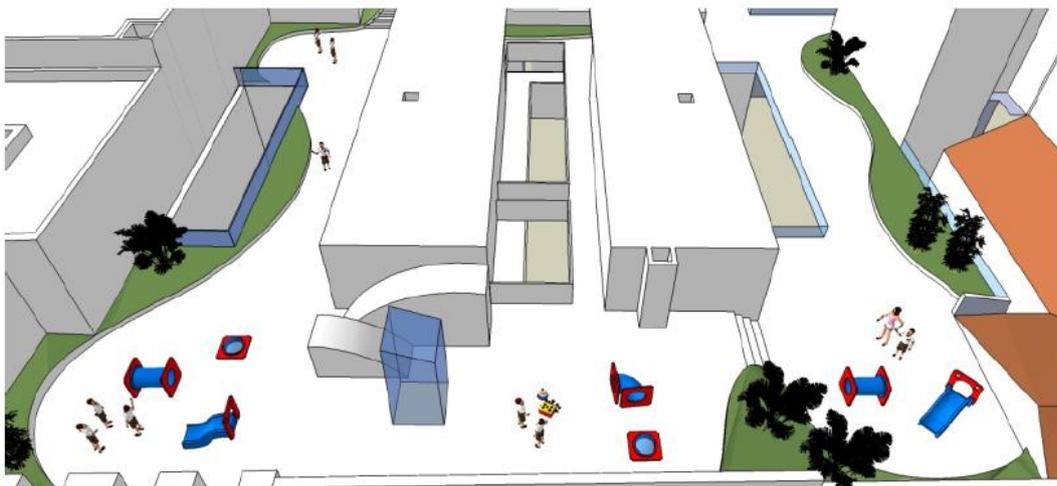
Imagen 3D de la zona de juegos prevista en la cubierta de la manzana 303. Fuente: Elaboración propia.
